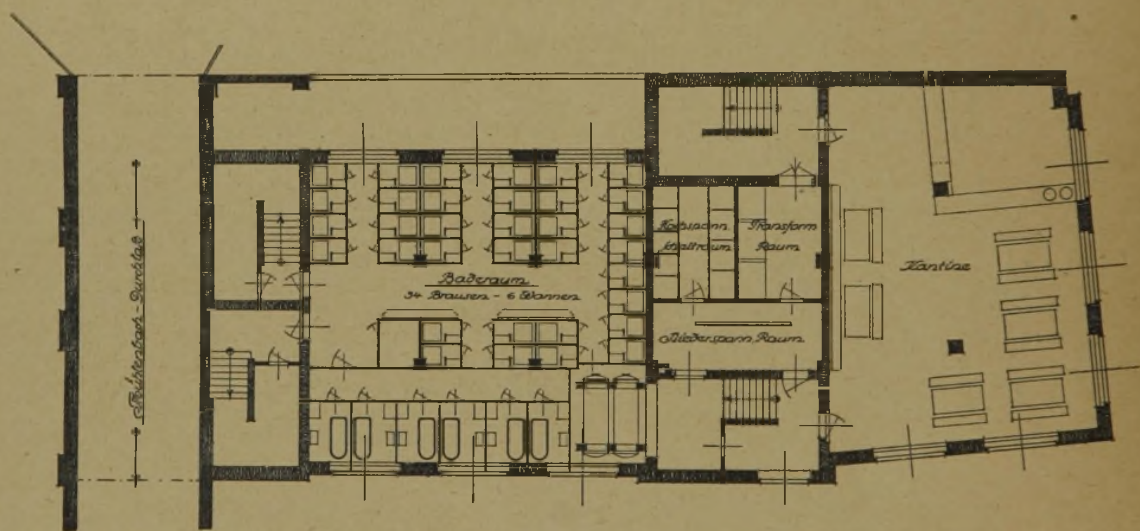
Grundriß des Kellergeschosses. (1 : 300.)
